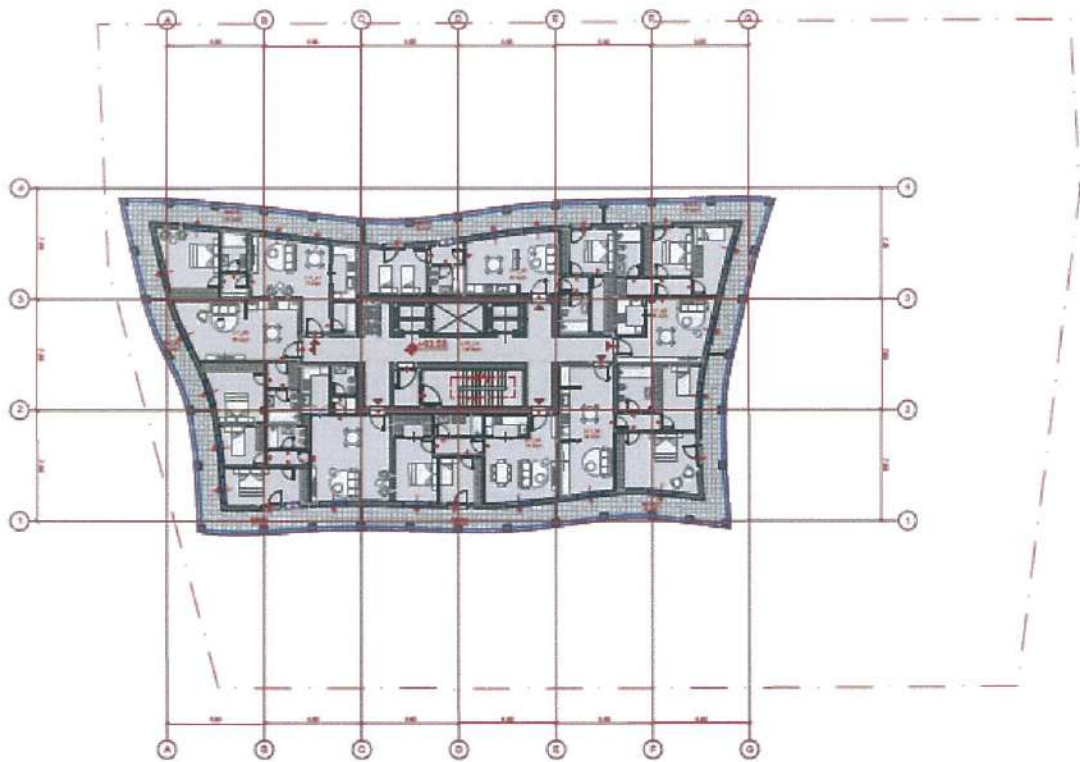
Planimetria e katit 16, në kuotën +63.58 SIP 912 m²
